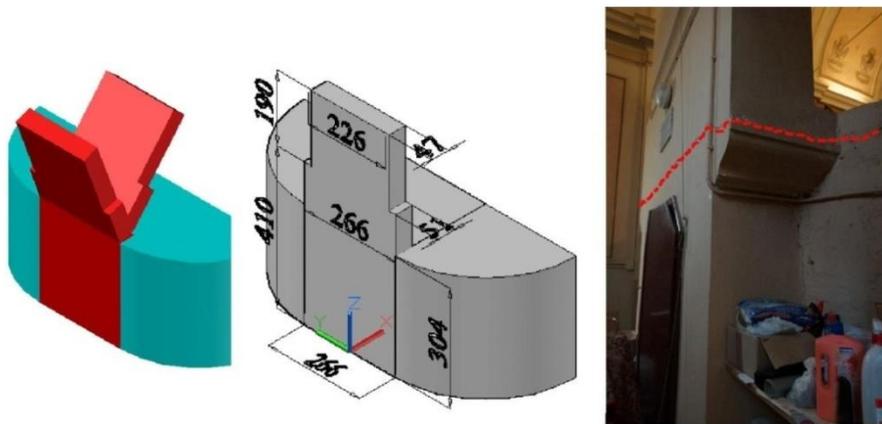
Dimensioni in cm dell'altare e meccanismo di rocking.
